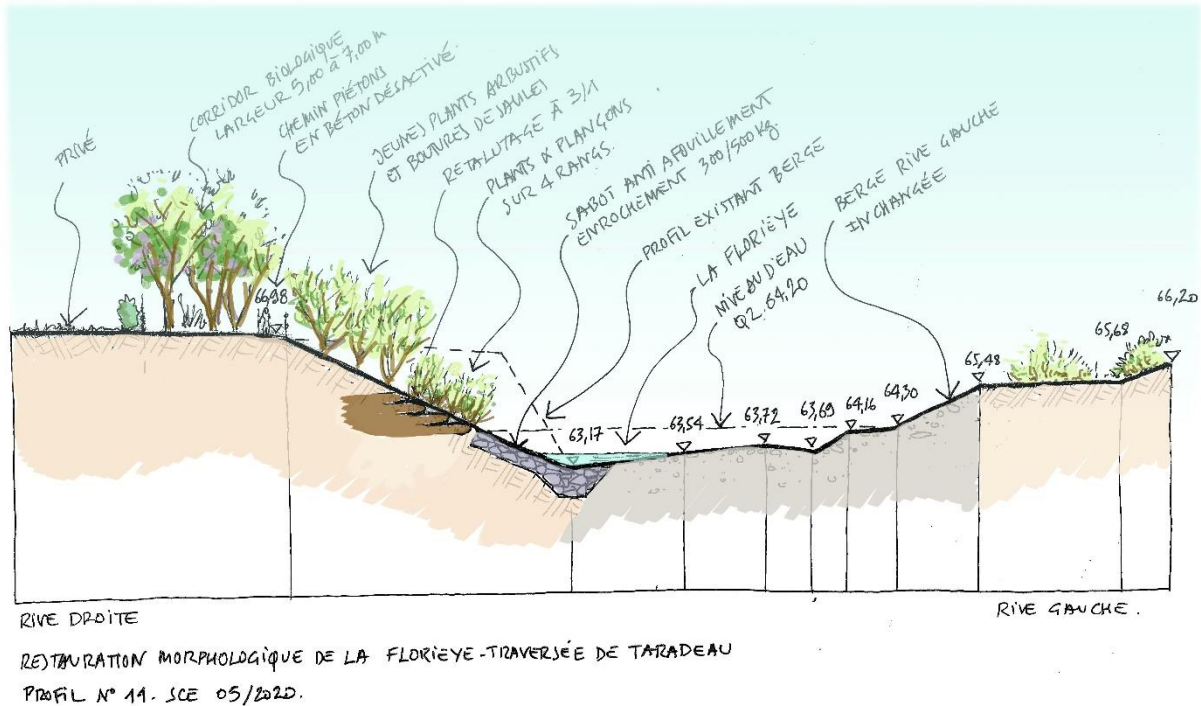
Coupe transversale du projet d'aménagement de la Florièye - profil 11 - Rive droite
